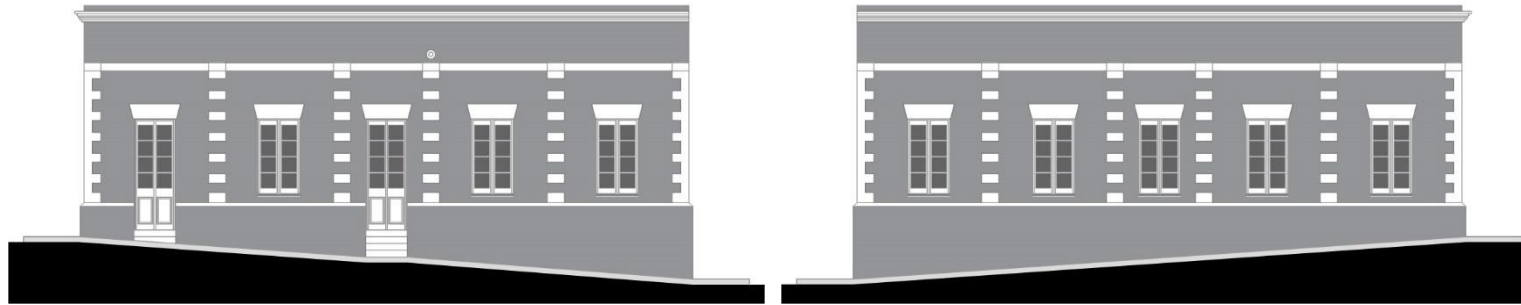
e 06.23: Fachadas nordeste e sudoeste (hipótese do autor).
